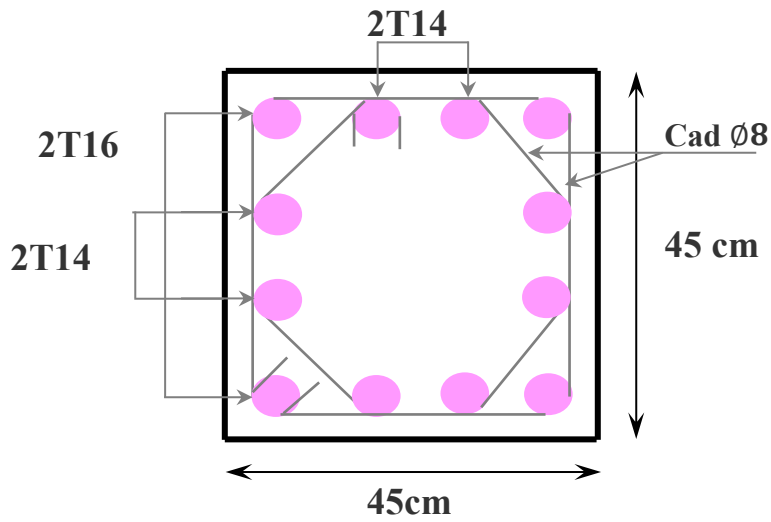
Schéma de ferraillage des poteaux 45x45.
